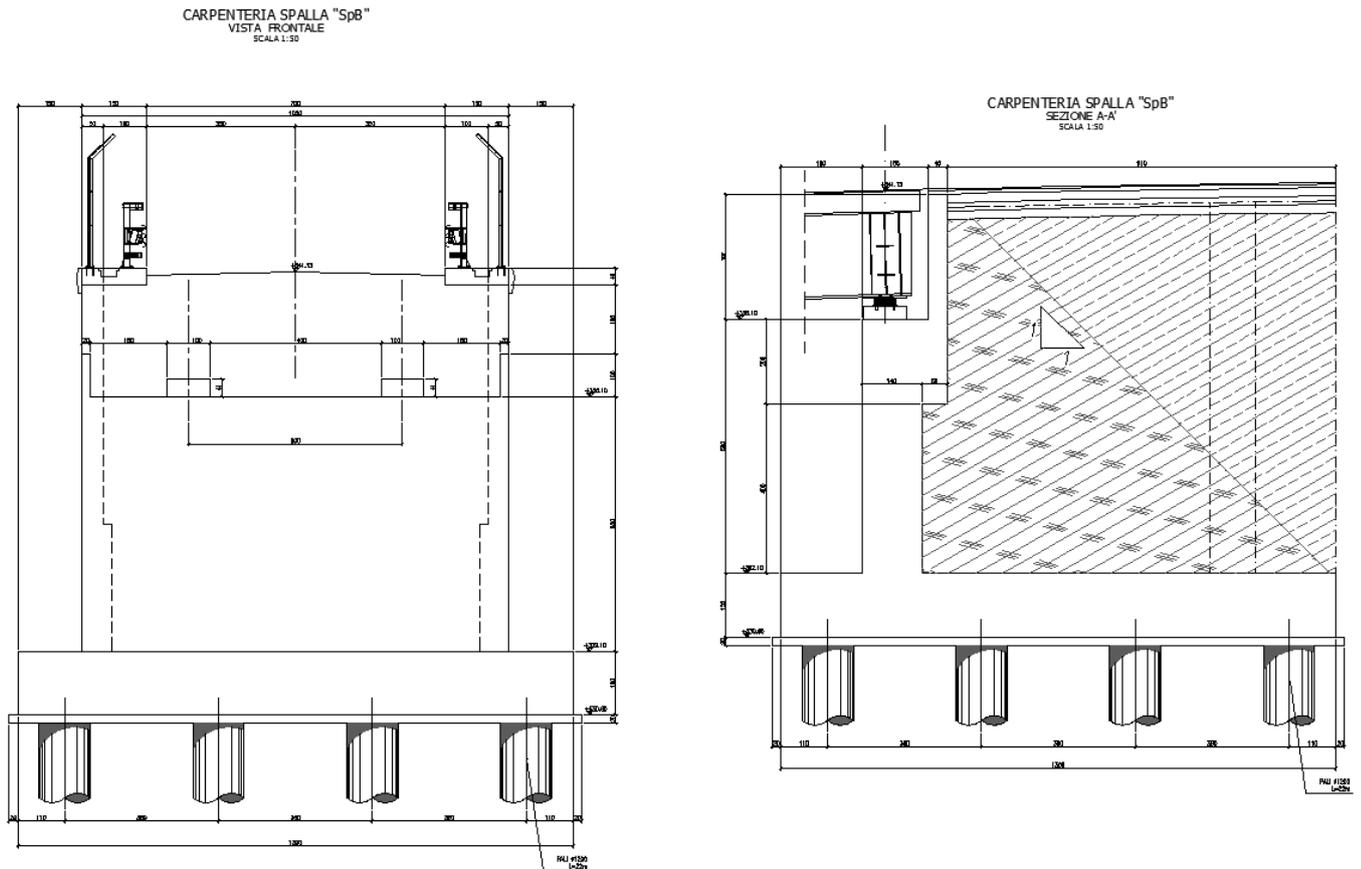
Sezione e prospetto spalla B.
